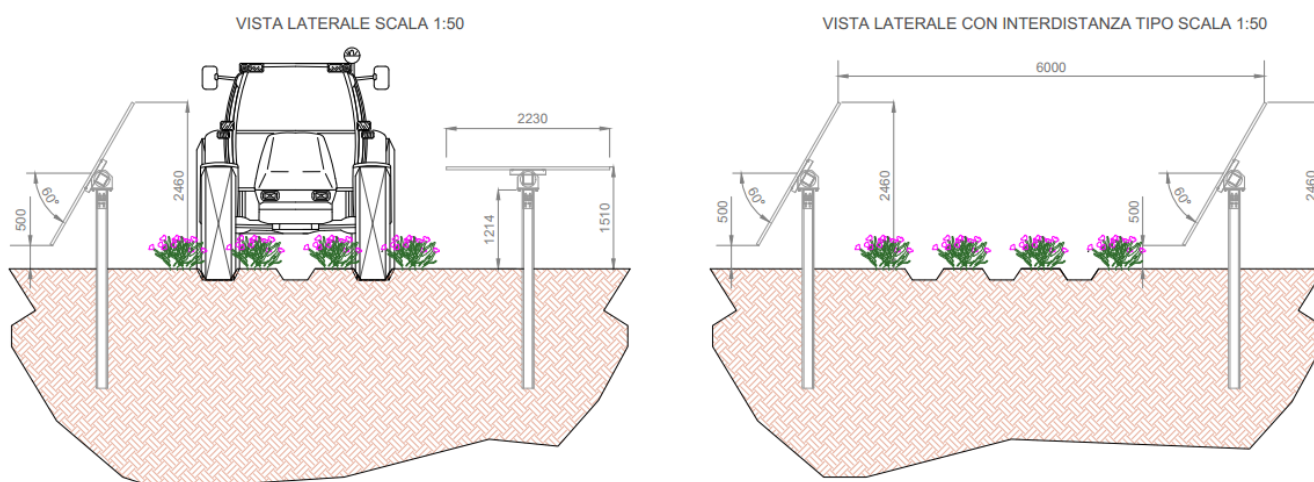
Schema della struttura –vista trasversale e vista longitudinale
